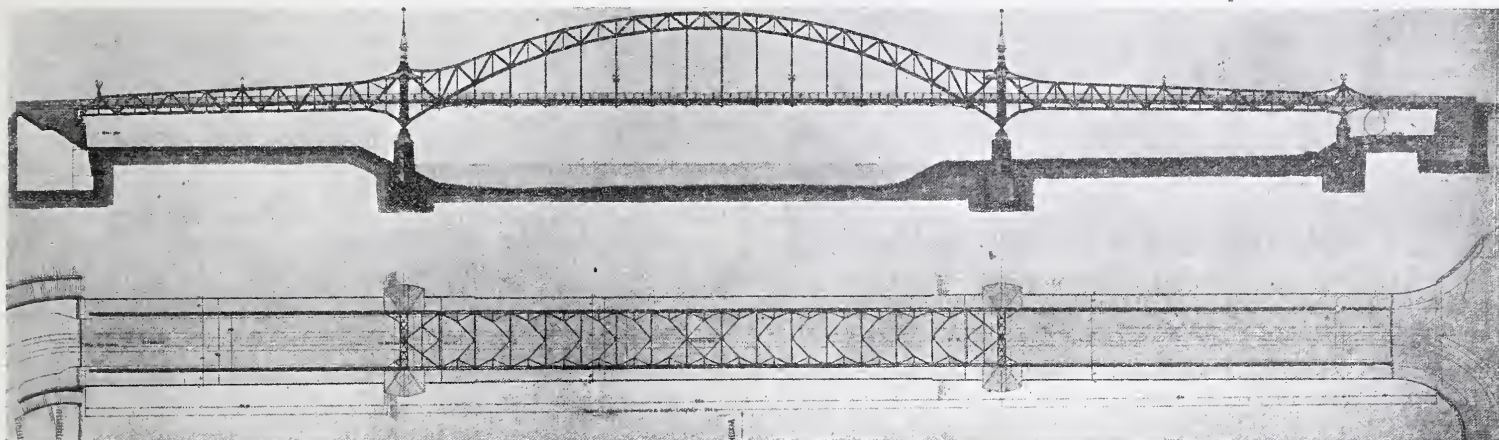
Ansicht und Grundriss der Brücke.
